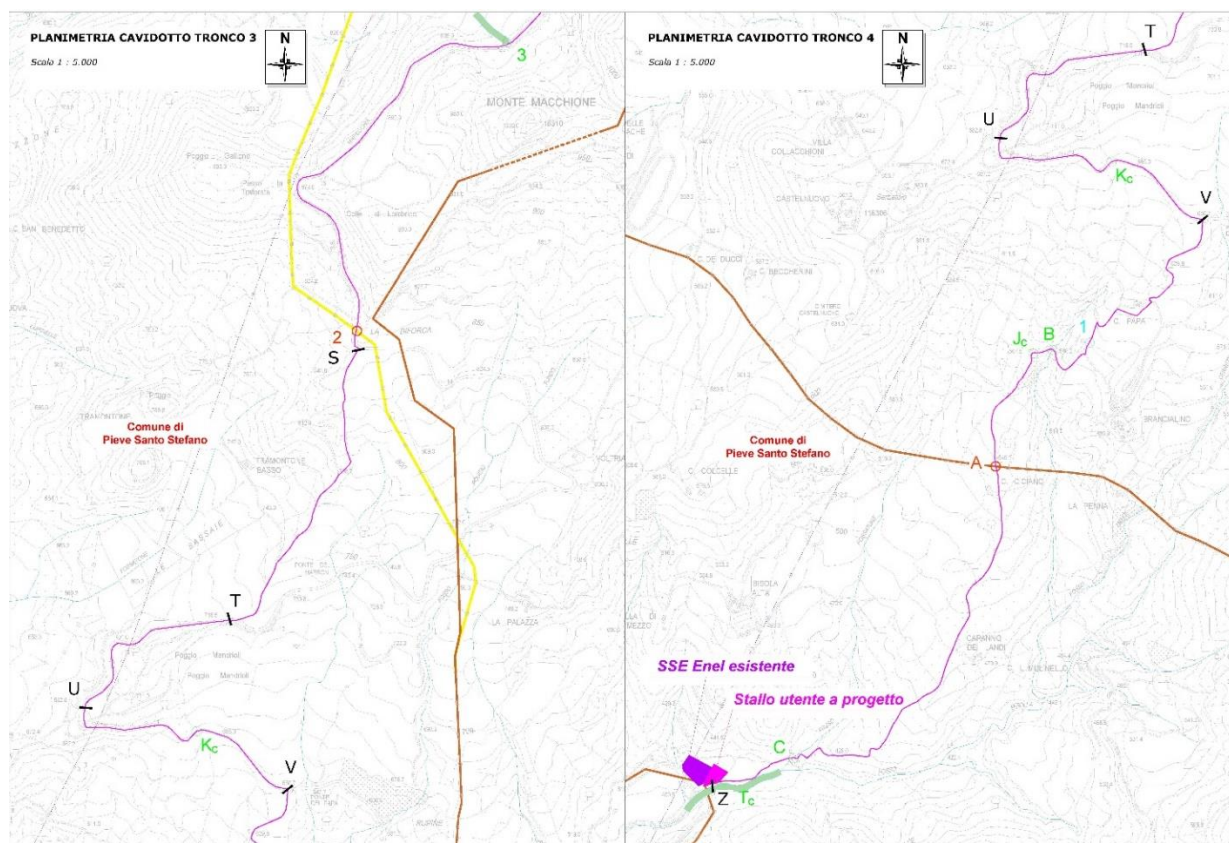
Estratto elaborato grafico PSS-4.17\_Cavidotto: Planimetria su CTR-pianta e sezioni; vista tronco 3 e tronco 4
